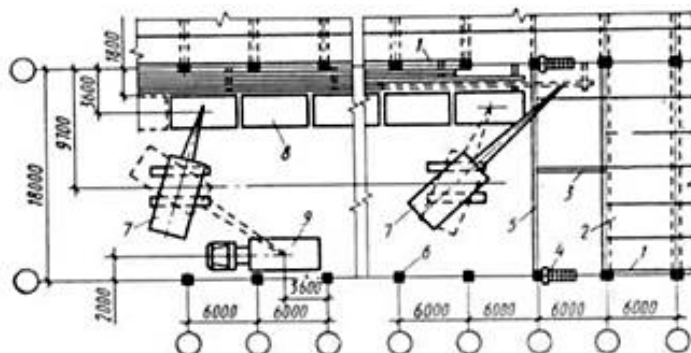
Схема выгрузки, раскладки элементов и монтажа покрытия пролетом 18 м, с шагом колонн и ферм 6 м продольным методом: 1 – временное ограждение; 2 – смонтированное покрытие; 3 – инвентарная распорка для временного крепления ферм; 4 – лестница-площадка приставная; 5 – стропильная ферма; 6 – колонна; 7 – кран; 8 – штабель плит; 9 – транспортное средство.
